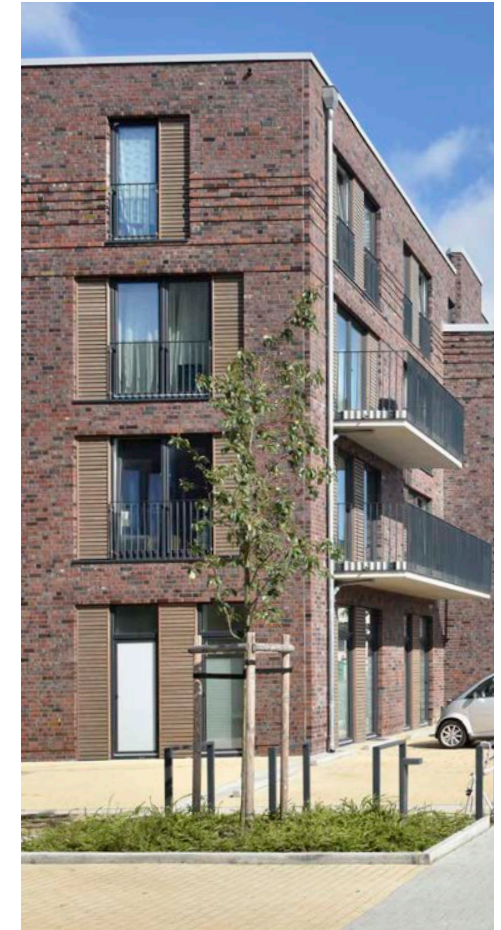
| Geschosswohnungsbau mit Klinkerfassade
